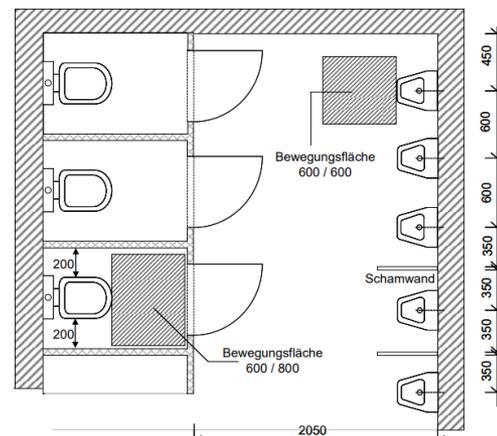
Einbündige Toilettenanlage mit Urinalen, Türanschlag nach außen (Maße in mm)
